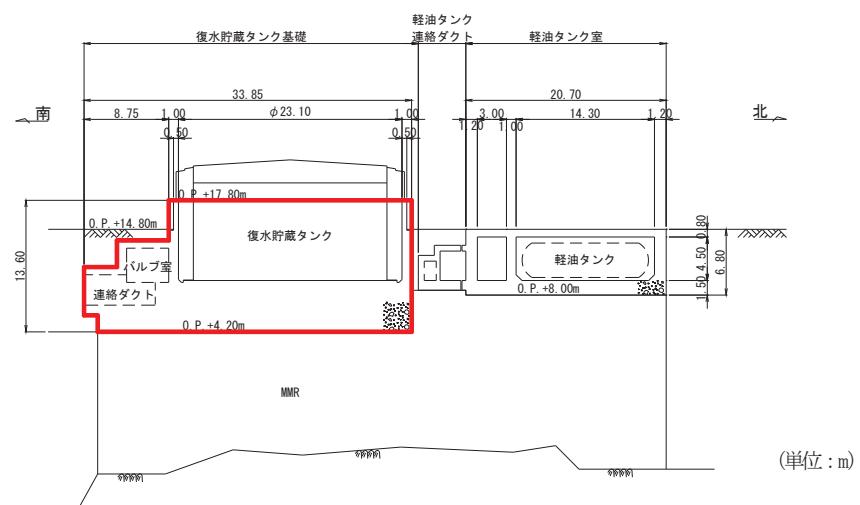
復水貯蔵タンク基礎断面図 (A-A)
